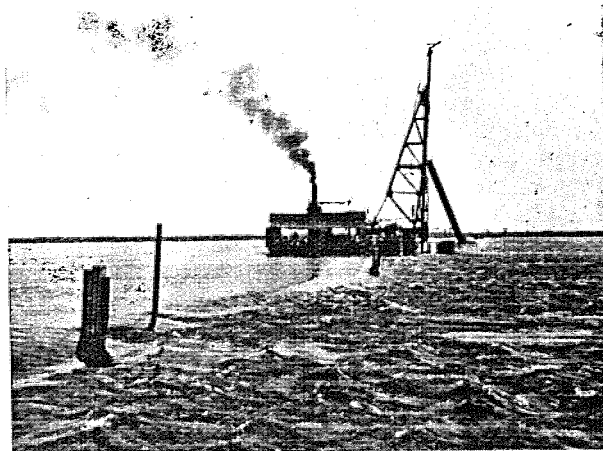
La sonnette de Mukag, construisant la doublure B devant les palplanches 700-737 (14 juin 1936).
